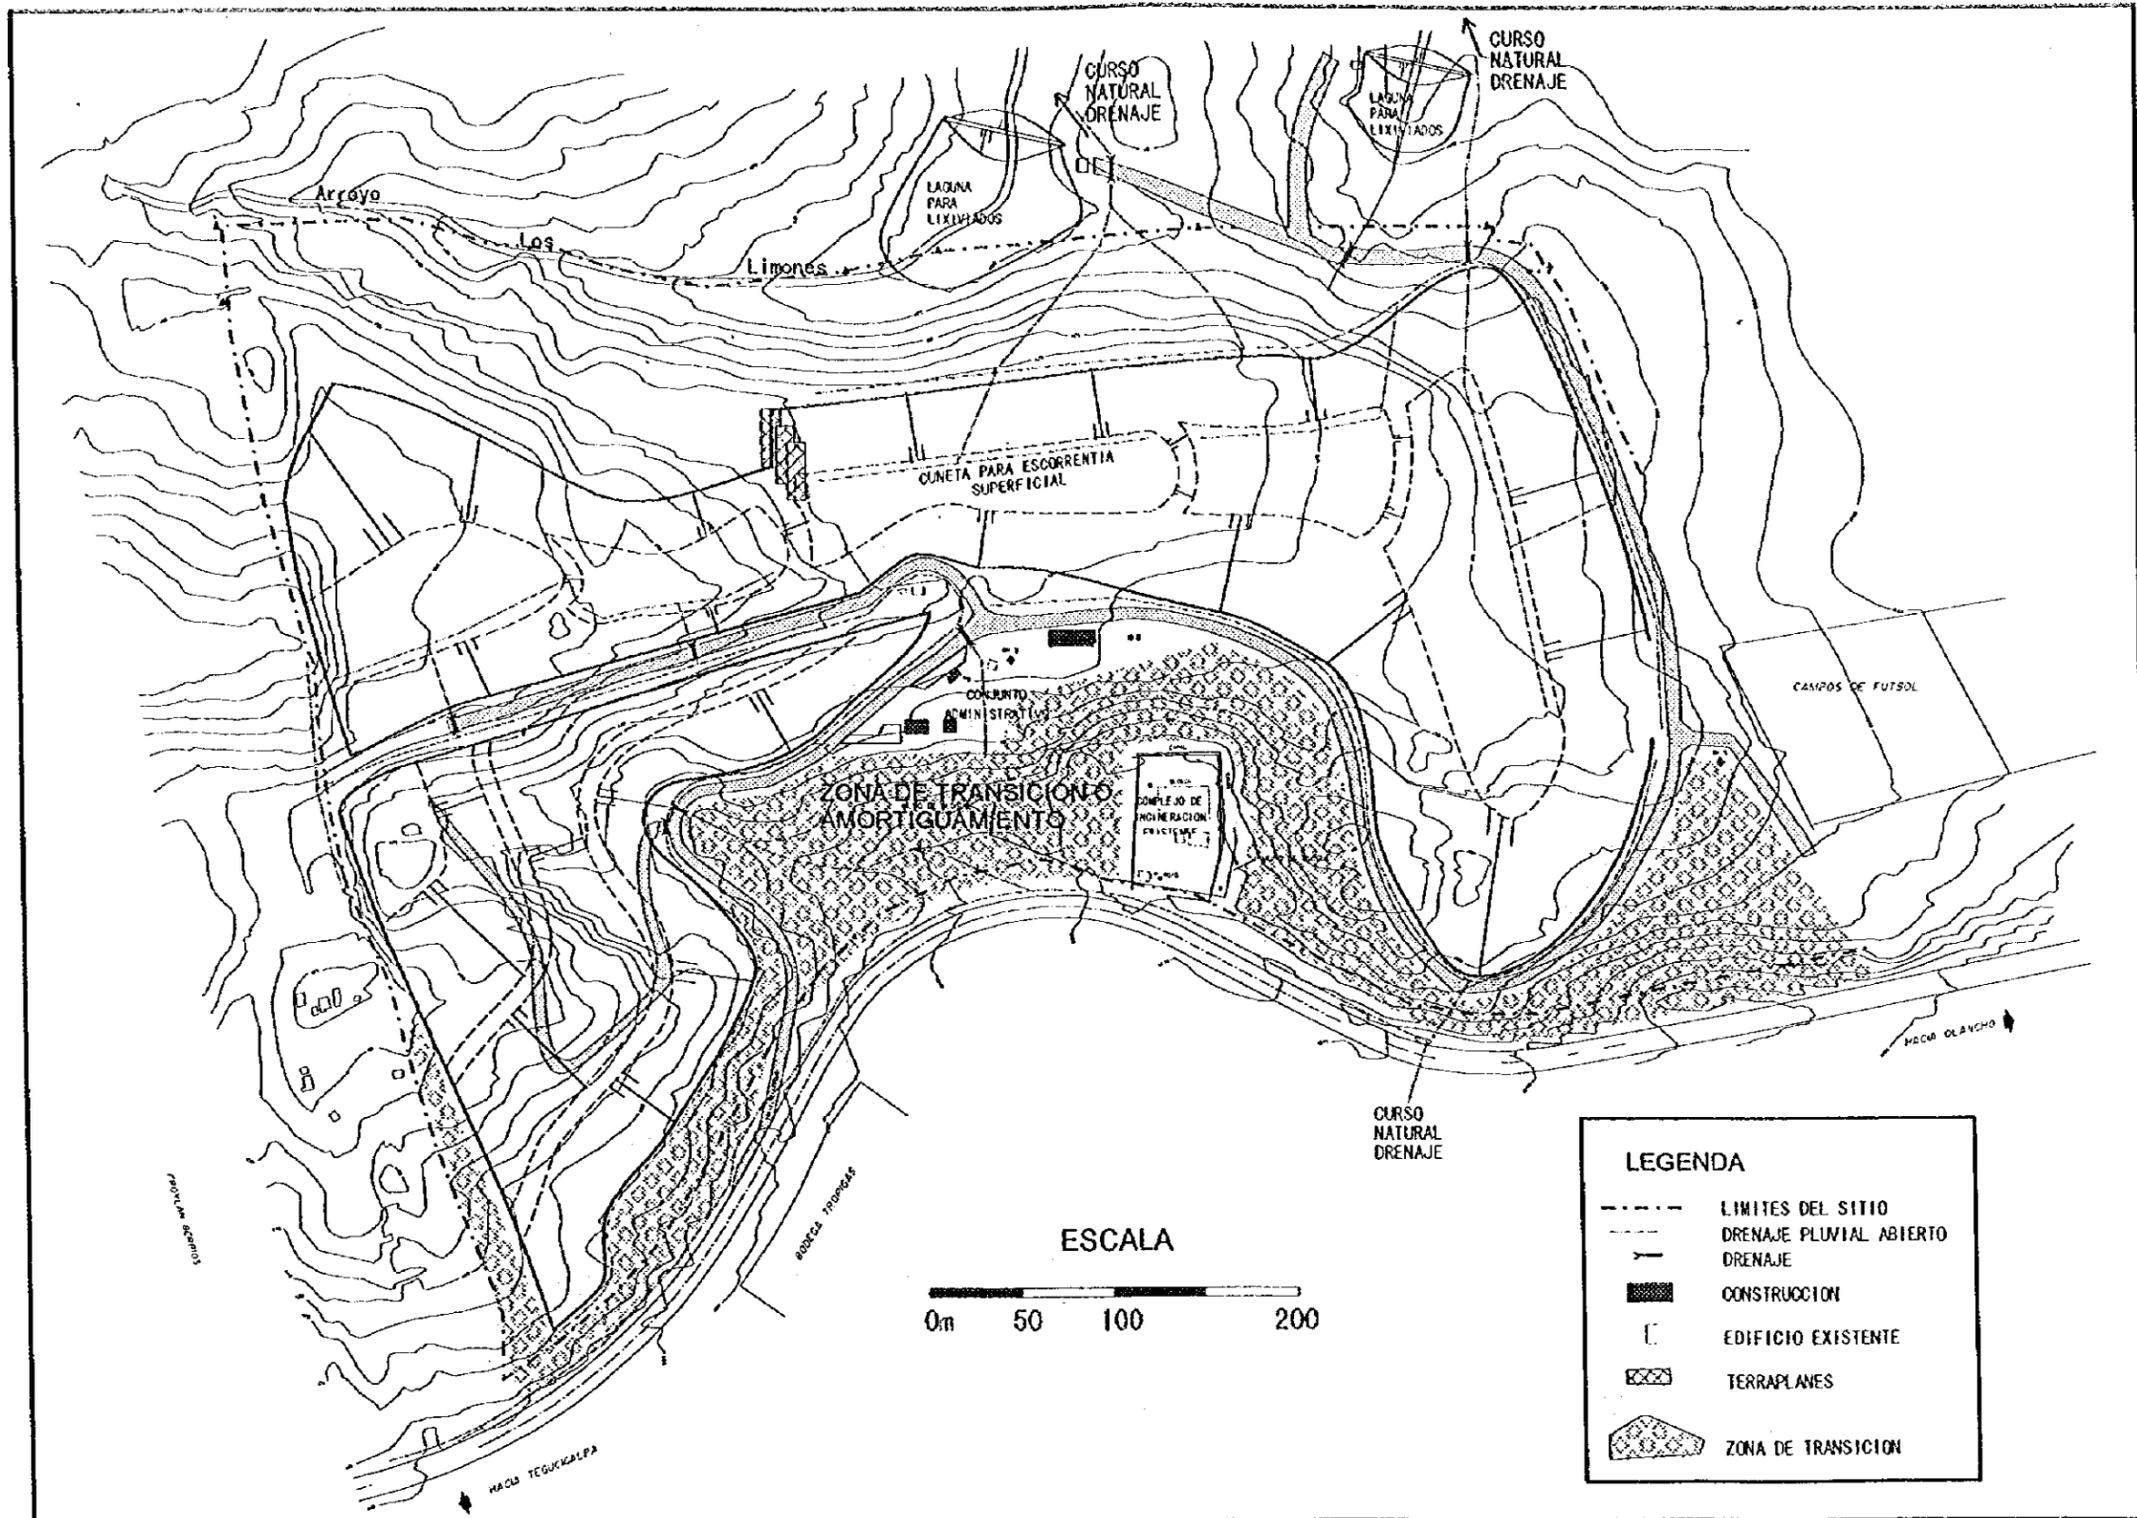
Plano Esquemático del Sitio de Disposición Mejorado
